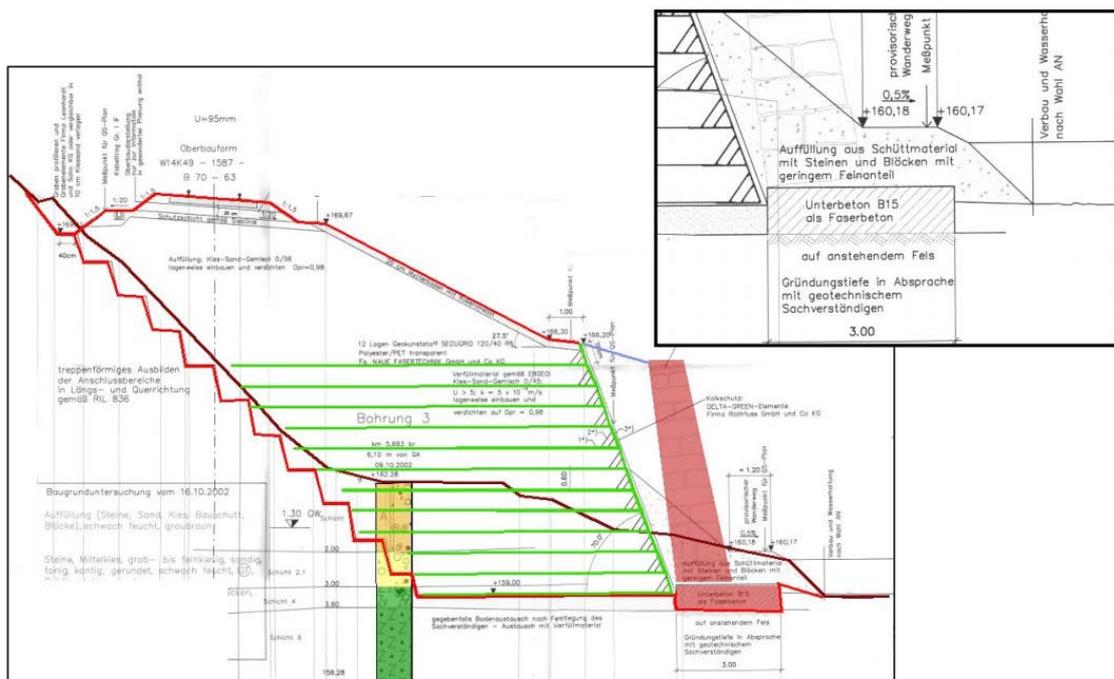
Sanierungslösung mittels Secugrid® Geogitter-Bewehrte-Erde-Konstruktion
